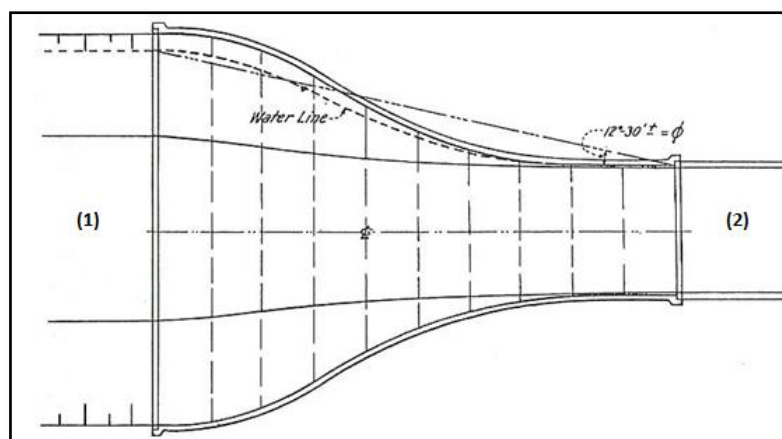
Estrutura de transição de montante segundo Hinds (1928) Planta com: 1. Canal de montante; 2. Túnel de desvio provisório (Smith, 1967).
